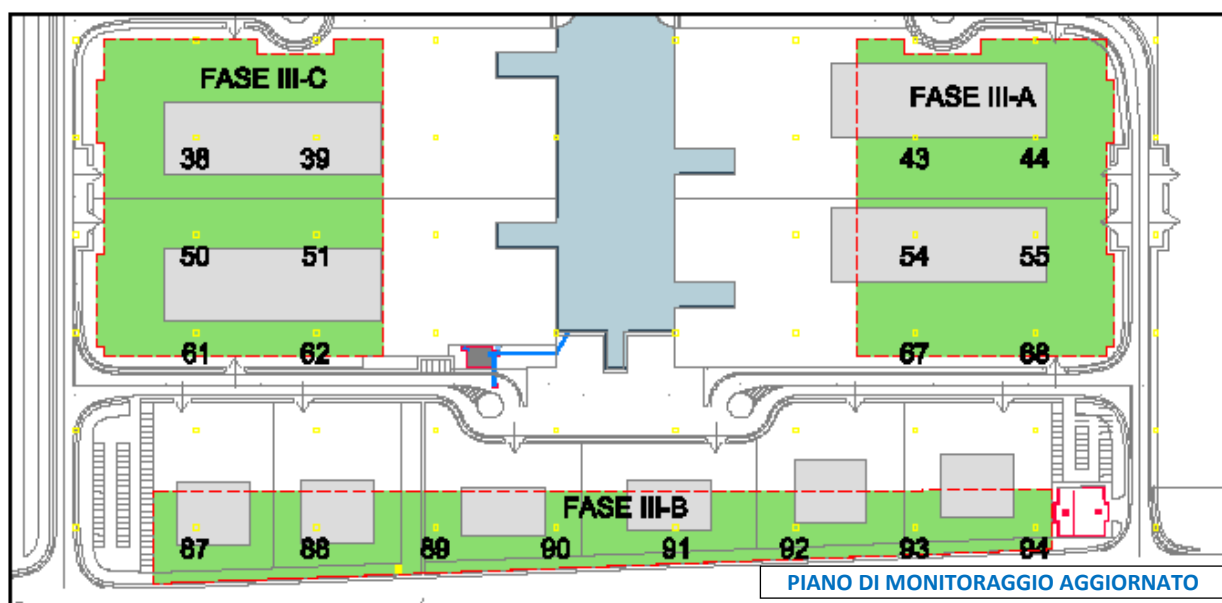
Planimetria delle stazioni di monitoraggio di FASE III.
